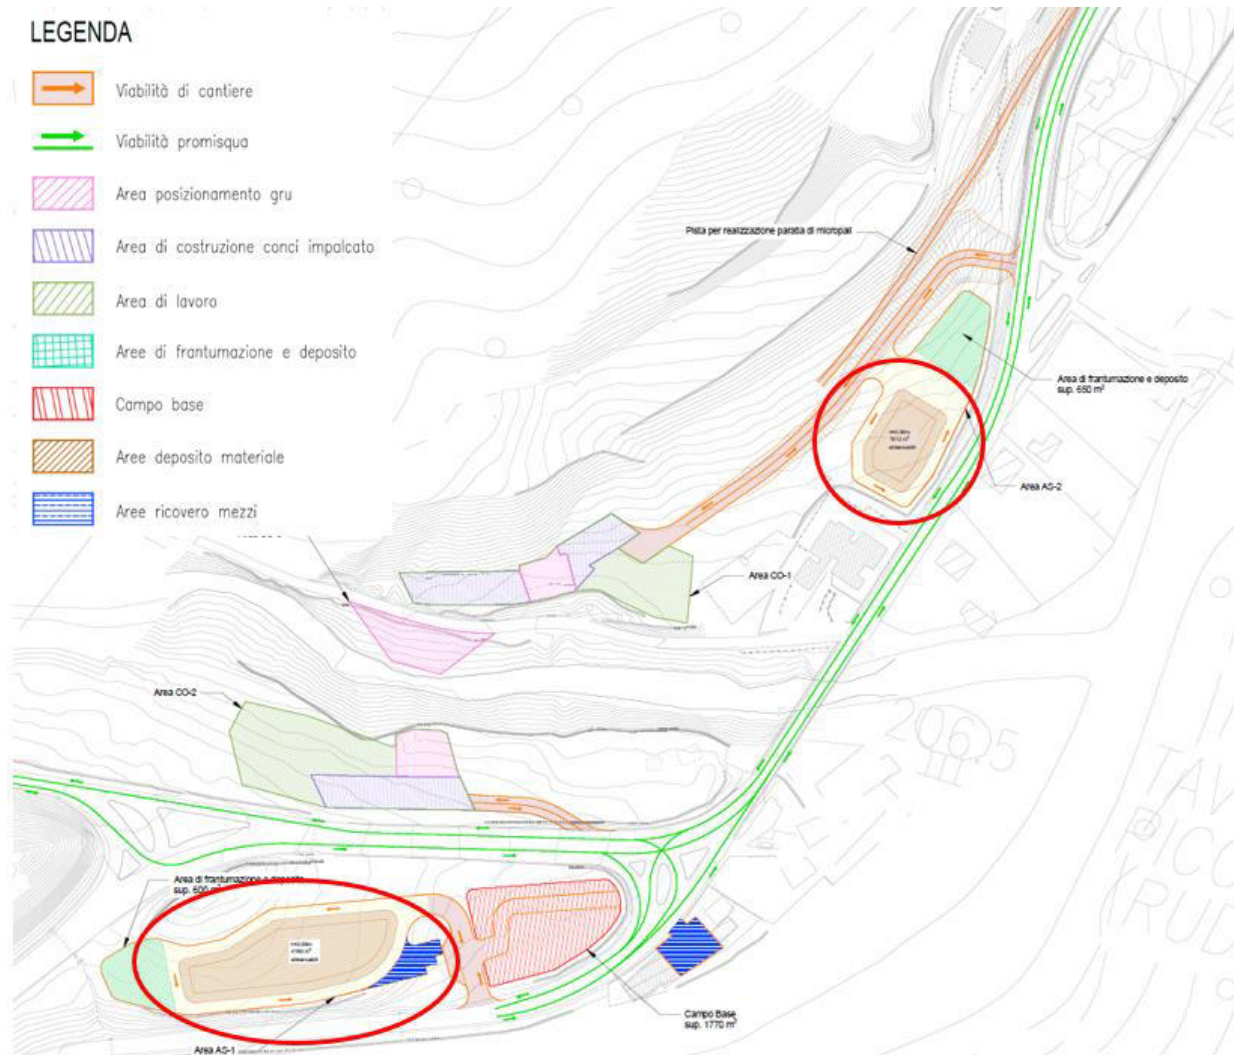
Stralcio planimetrico localizzazione aree di deposito e viabilità di servizio
